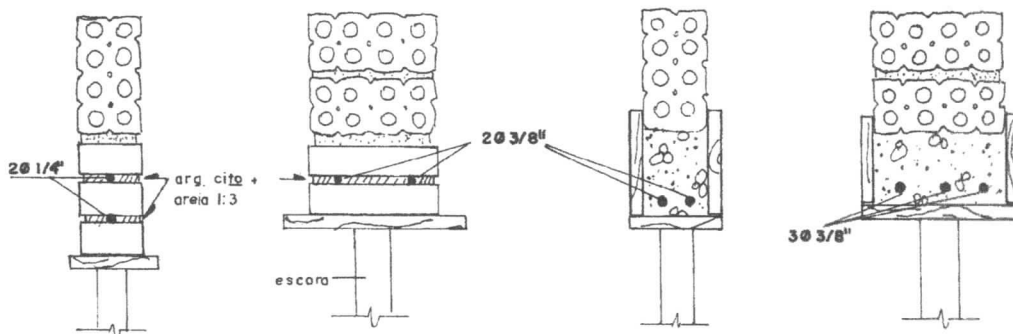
Vergas em alvenaria de tijolo furado para vãos até 1,00m e entre 1,00m e 2,00m
